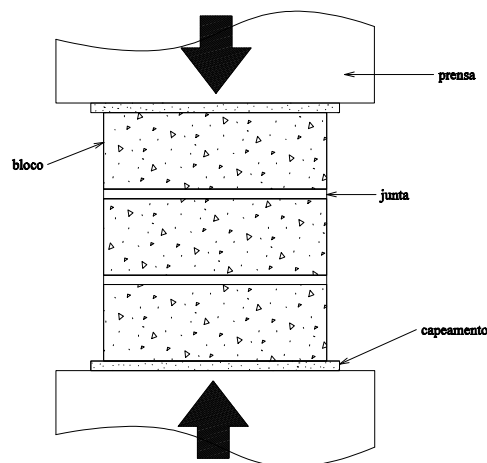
Ensaio de compressão de um prisma constituído por três blocos de concreto ou de material cerâmico e duas juntas horizontais
